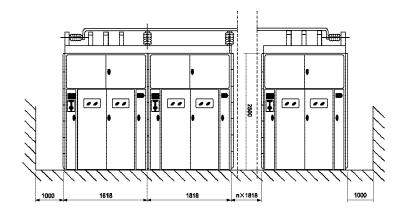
拼柜安装尺寸 Illustration8 the installing size of the splice board
